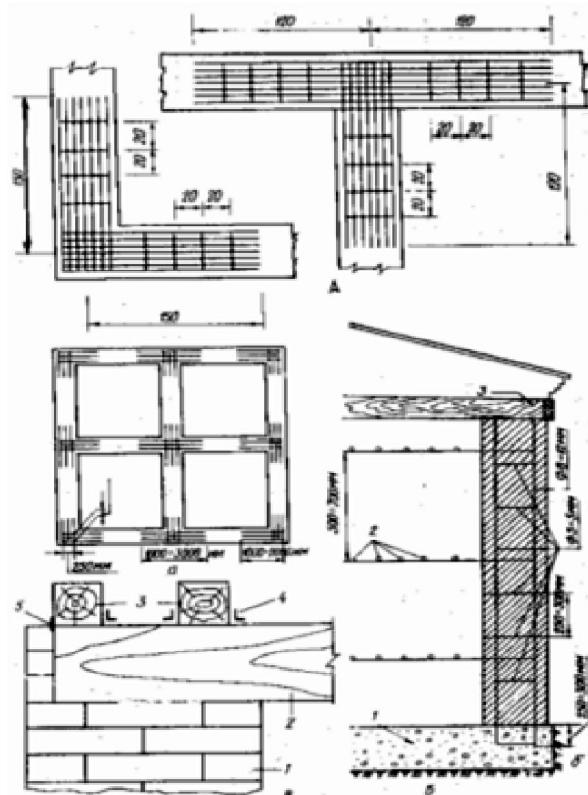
Армирование стен: А – усиление стен в угловом соединении и в опряжении стен; Б – схема армирования кирпичных стен: а - схематический вид в плане на армирование; б - поперечный вид армированных кирпичных стен: 1 - фундамент; 2 - арматурный каркас; 3 - балка; В – установка прогонов и опор на фундамент: 1 - фундамент; 2 - прогон; 3 - нижний каркас (синчлар); 4 - уголок; 5 - металлическая планка.
